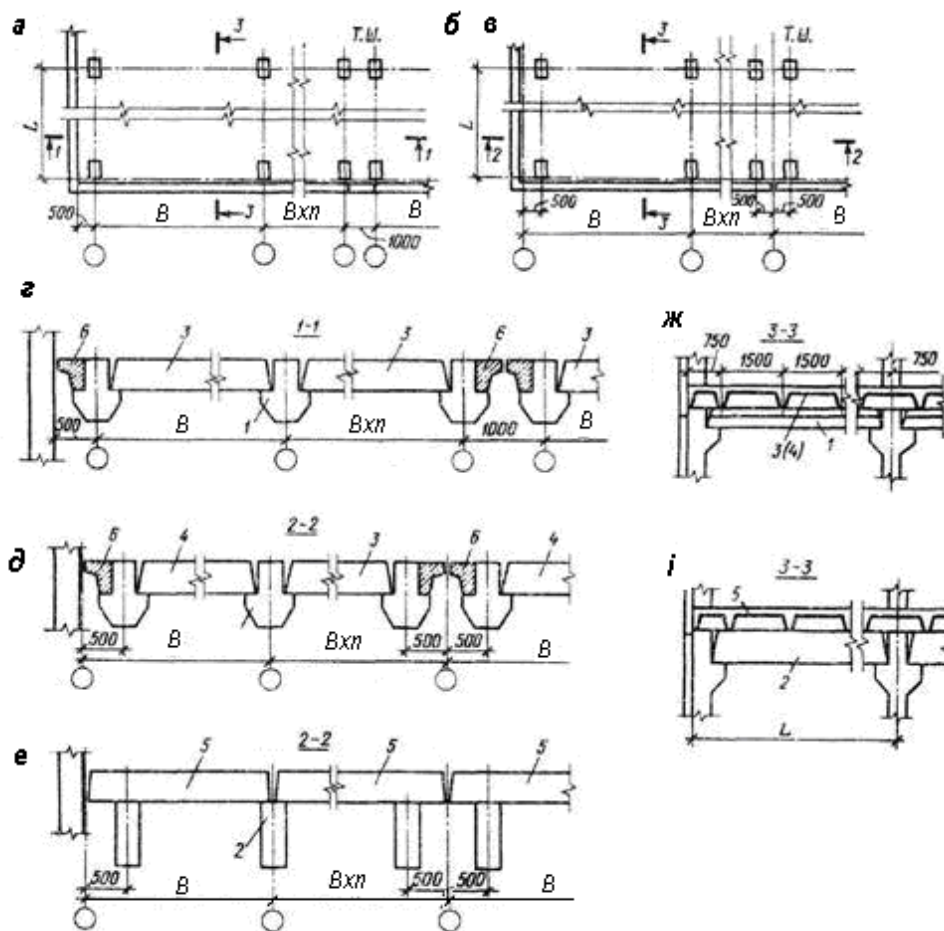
Рішення торців і температурних швів при укладанні плит типу 1 і 2: а – схема плану перекриття з плитами типу 1 номінальної довжини 5,55 м; б – те ж, з використанням укорочених плит у торців; в – те ж, з плитами типу 2; г, – повздовжній розріз для плит типу 1 номінальної довжини; д – те ж, для укорочених плит у торців; е – те ж, з плитами типу 2; ж, і – поперечні розрізи для плит типу 1 і 2; 1 – ригель з поличкою; 2 – ригель без полички; 3 – плита типу 1, довжиною 5,55 м; 4 – те ж, довжиною 5,05 м; 5 – плита типу 2, довжиною 5,95 м; 6 – добірні елементи
